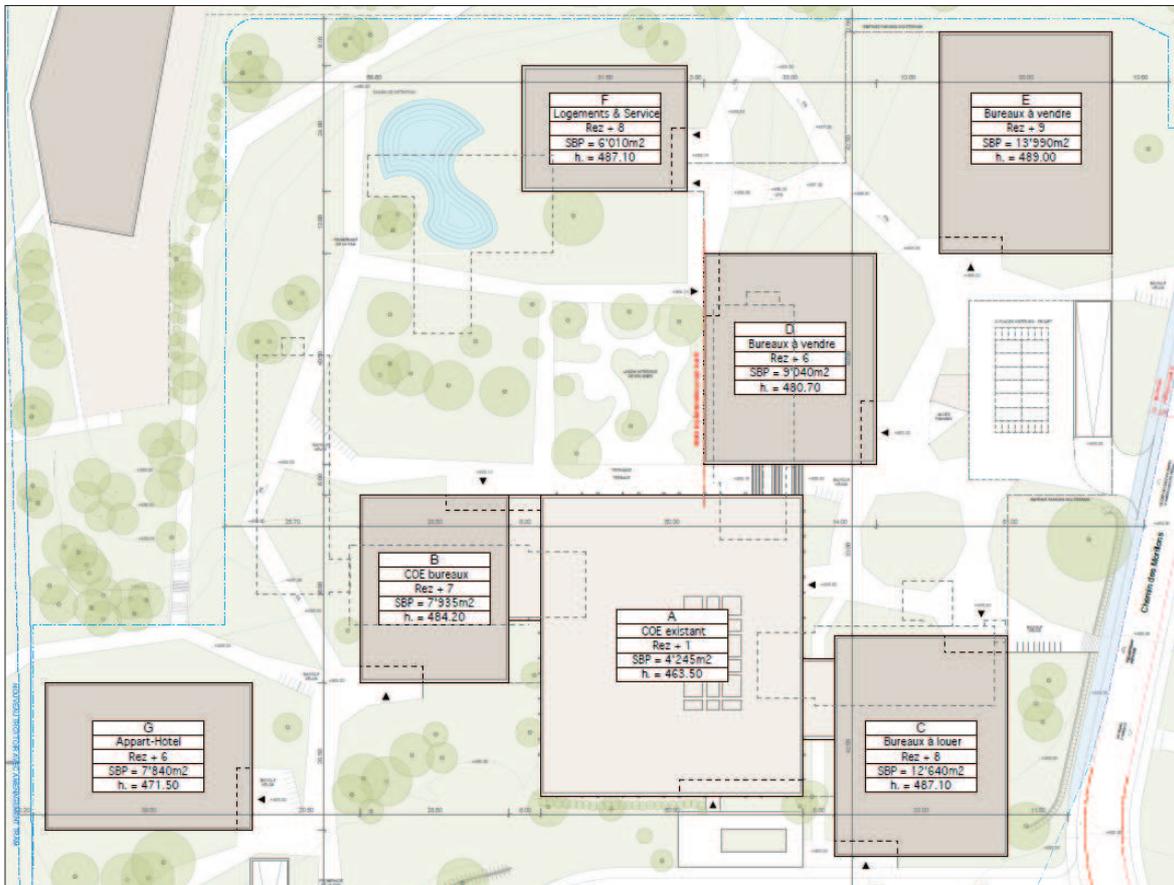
Plan masse des bâtiments A à G projetés (source : LRS architectes)
